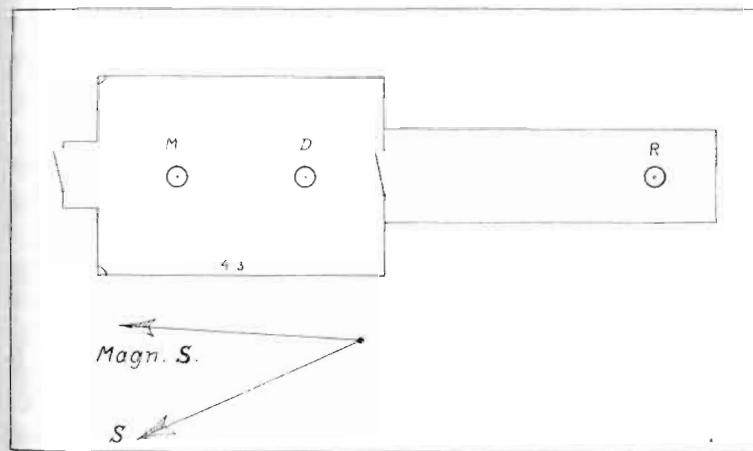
Grundriss av det magnetiske observatorium.
